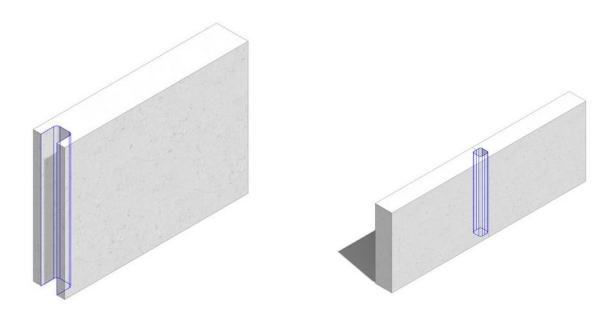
Réservations verticales : Piliers - Encadrements d'ouvertures.
